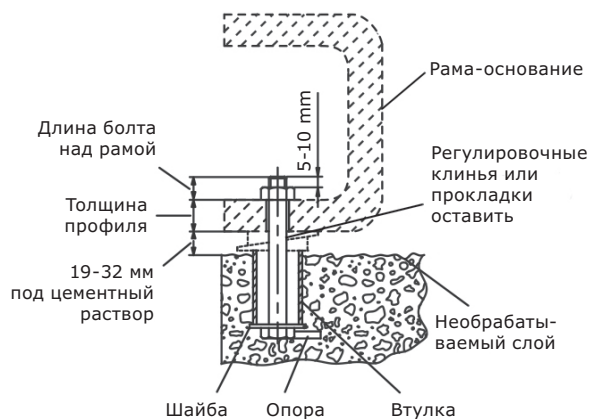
Типичная конструкция узла крепления рамы-основания к фундаменту
